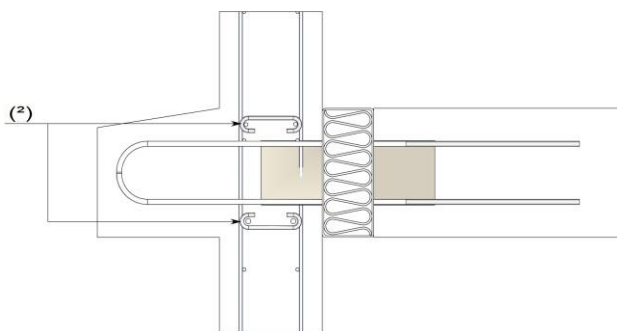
Chainage de mur – liaison dalle – casquette - disposition 1 (vue en coupe)
